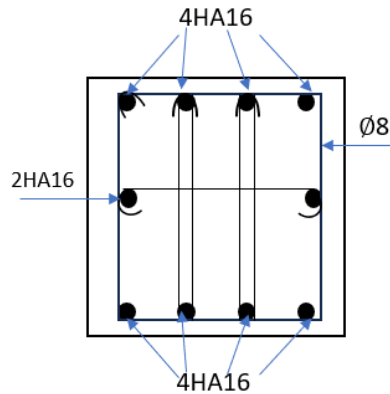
Schéma de ferrailage du Poteau (50×50) cm².
